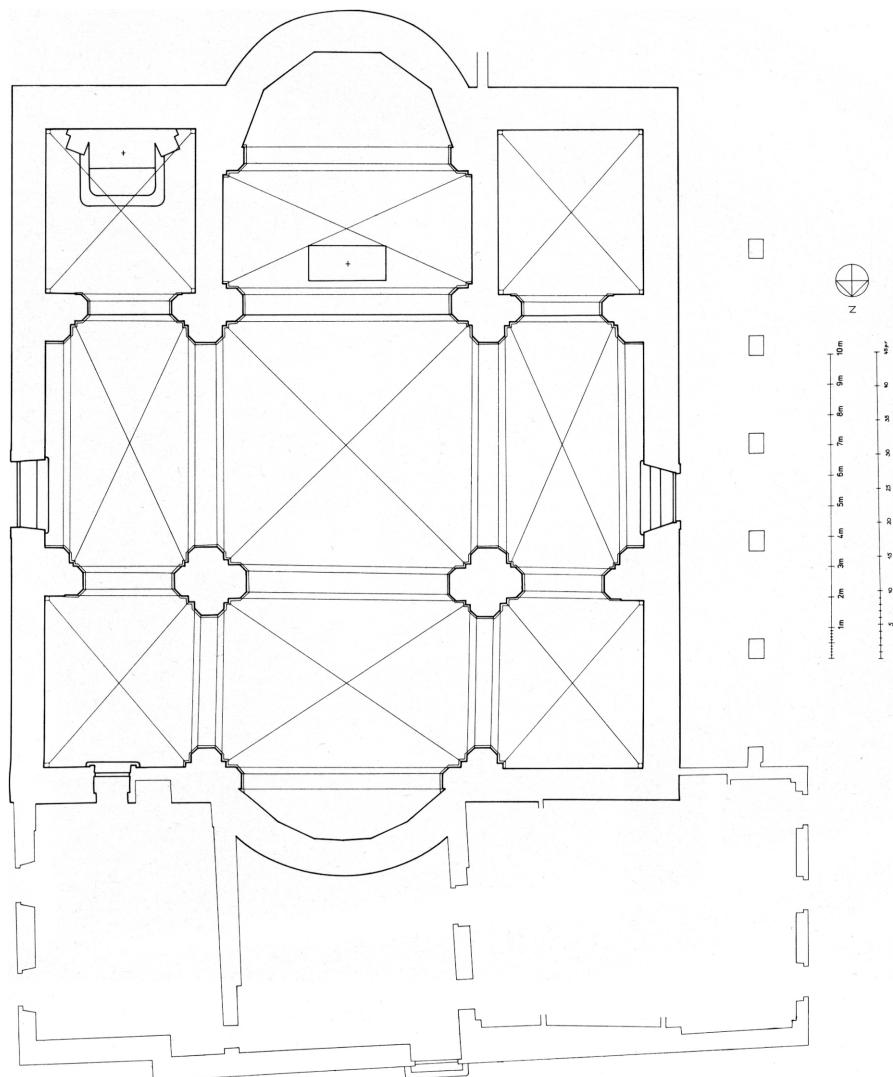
Santa Maria della Pietà, Grundriss nach I. Sailer 1988
